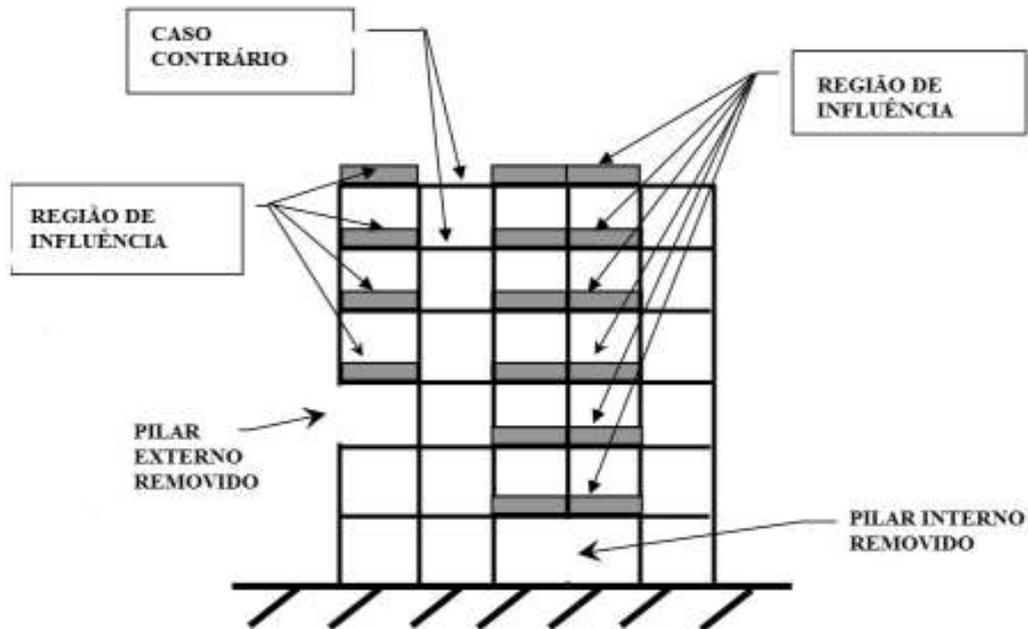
Comportamento estrutural de balanço e membrana em estrutura de concreto pré-moldado
